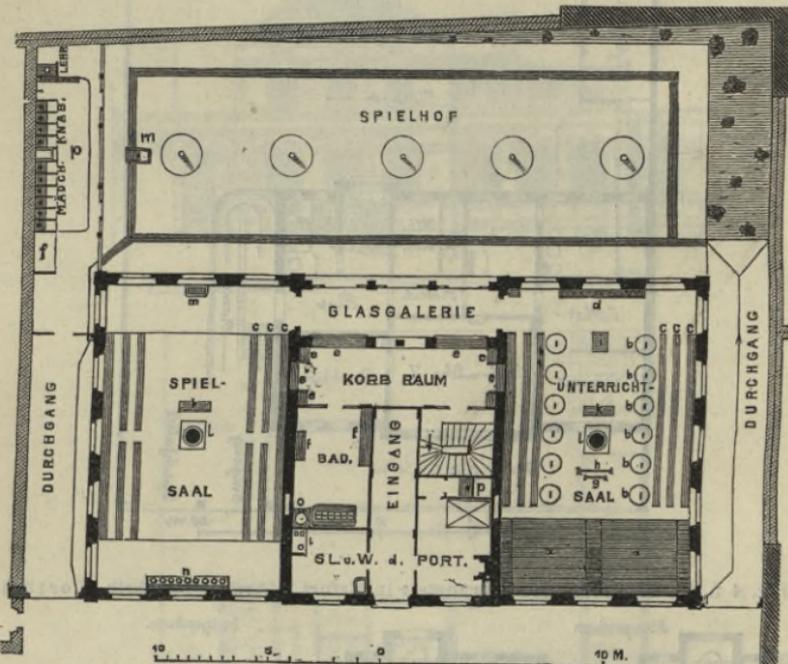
u. 5. Kleinkinderbewahranstalt in Erfurt.] (Arch.: Stadtbrth. Kortüm.)
